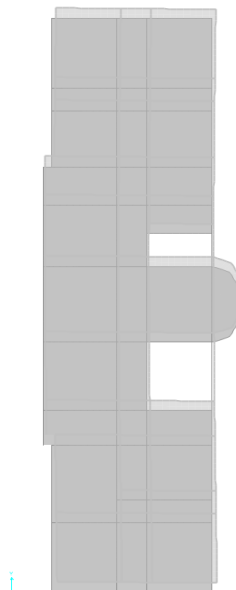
Vista en planta de la Deformada de la estructura debido al sismo en "X" - 6° piso.
